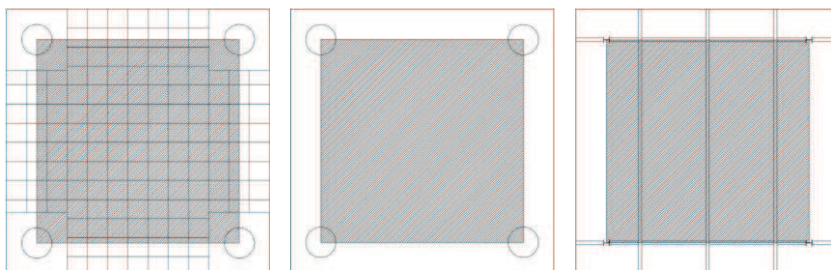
Laje aligeirada, laje maciça e laje metálica
